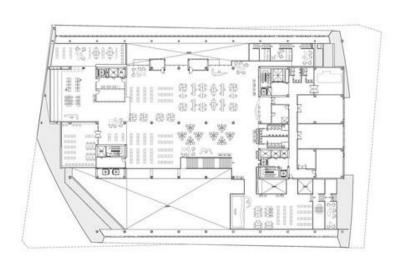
Planta Baja Biblioteca Nacional de Sejong
